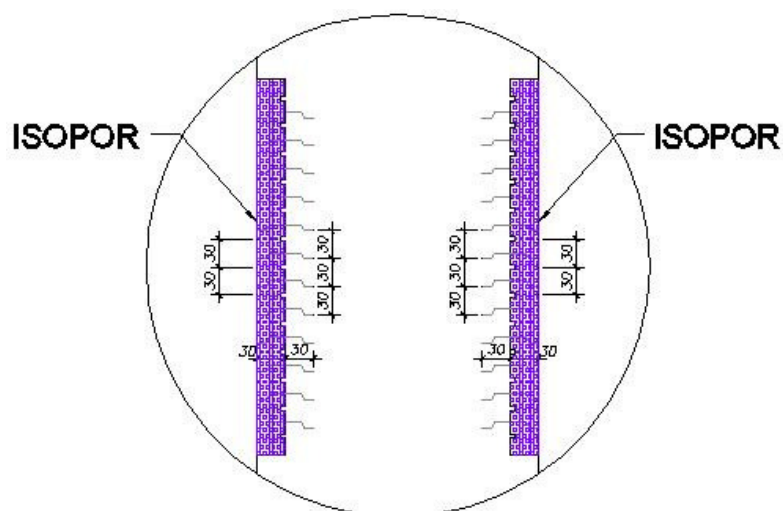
Pilar do modelo M8 com as fibras expostas na junta entre o consolo e o pilar
